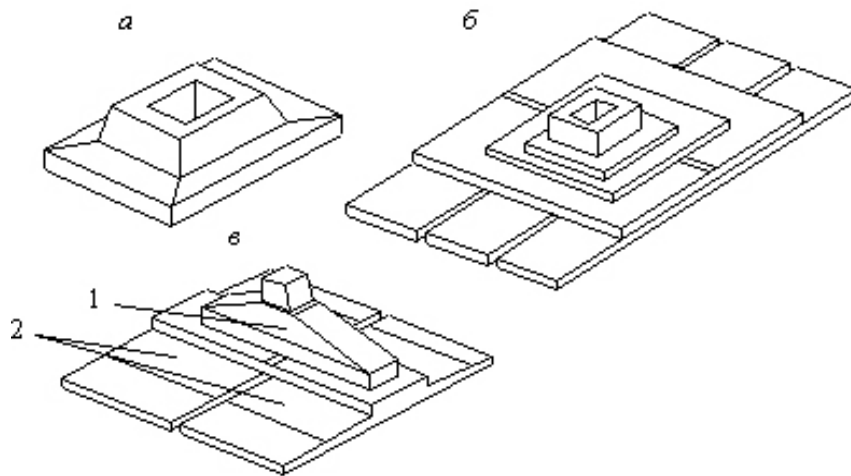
Збірні залізобетонні фундаменти під колону:
